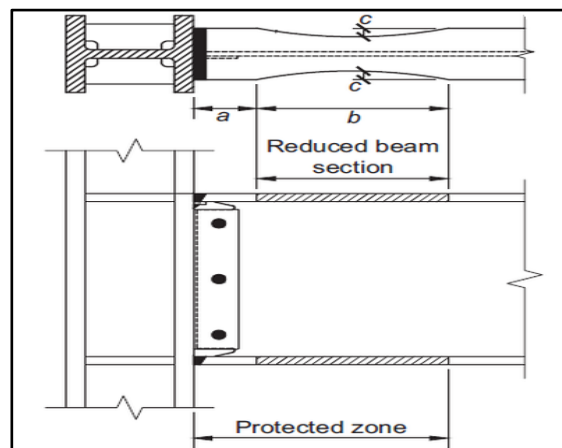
Modelo de conexión viga de sección reducida. AISC341 (2016)
